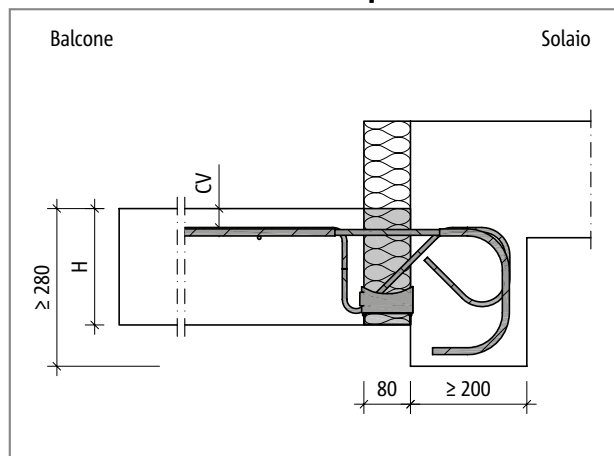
Schöck Isokorb® tipo K-UZ: balcone con abbassamento di quota e isolamento esterno
